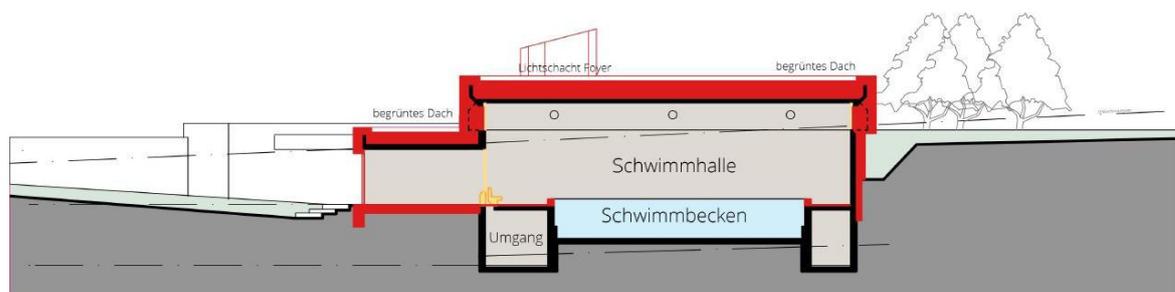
Prinzipschnitt Gebäudehüllensanierung
